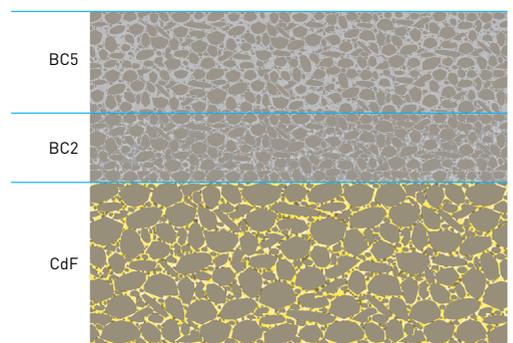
Coupe en travers-type BC5/BC2/CdF -
